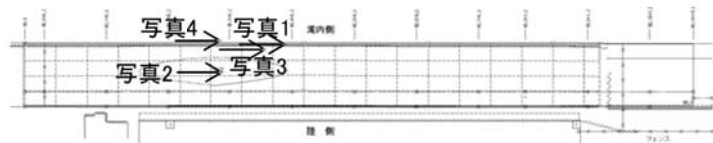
箱崎埠頭-10m 岸壁の被災状況
